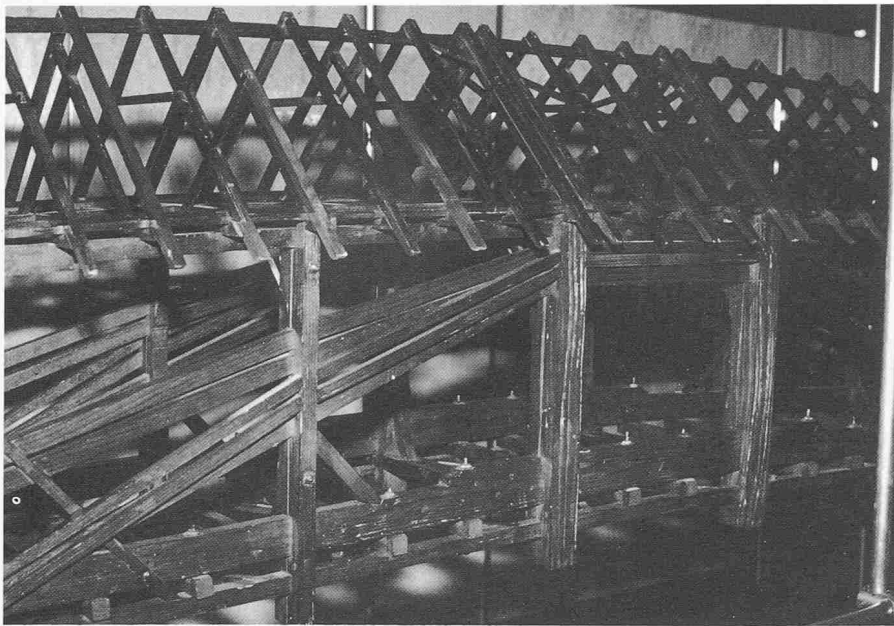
Modell einer gedeckten Holzbrücke, 18. Jahrhundert
